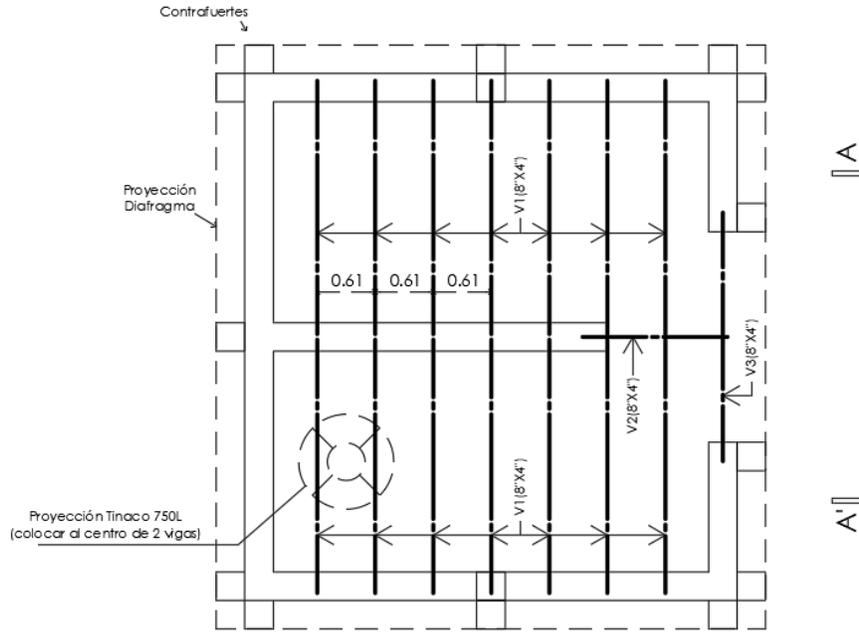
Plano de la primera propuesta de cubierta para baños. Imagen propiedad del autor.
